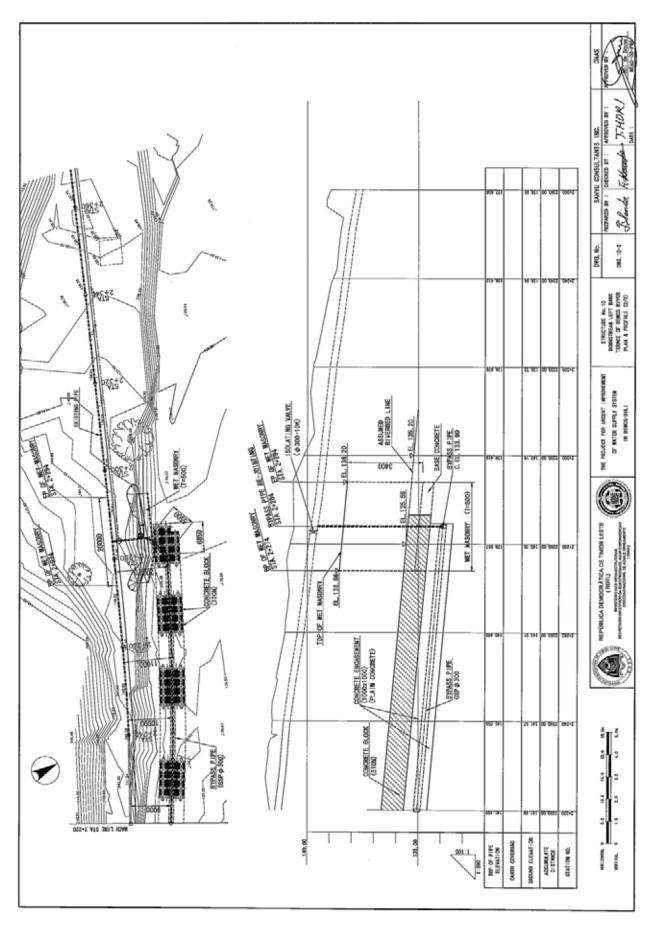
改修箇所 No. 11: ベモス川左岸側斜面山脚部 計画縦平面図 (その2)
